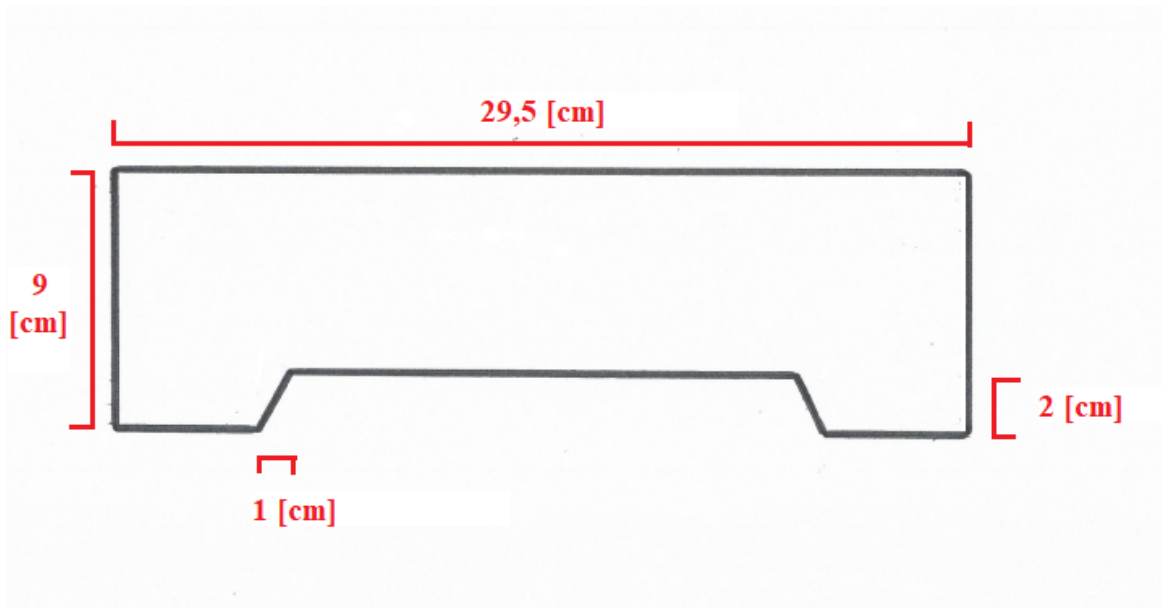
Dimension de la brique : vue en coupe longitudinale
